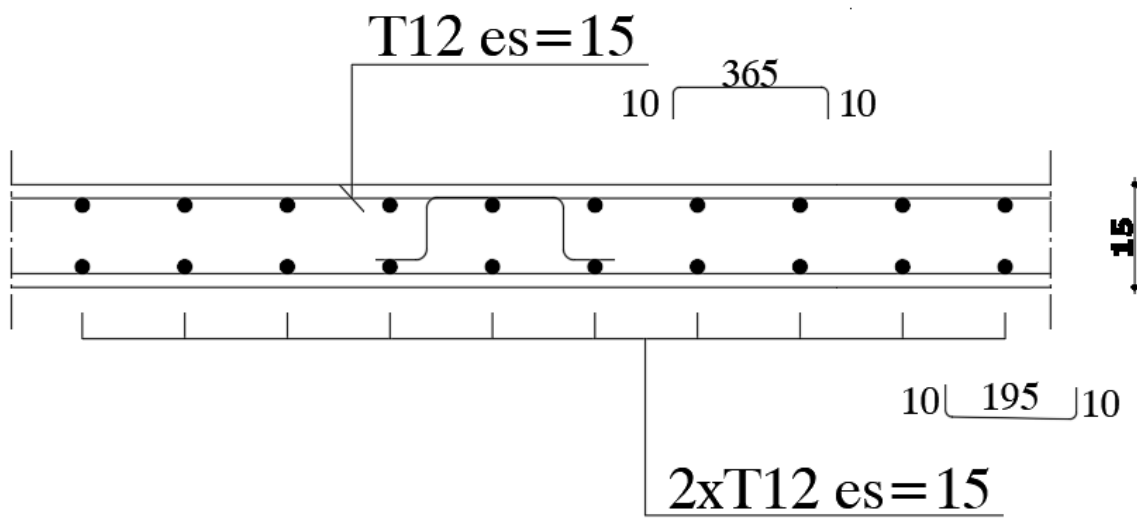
Schéma du ferrailage de la dalle pleine de la salle machine.
